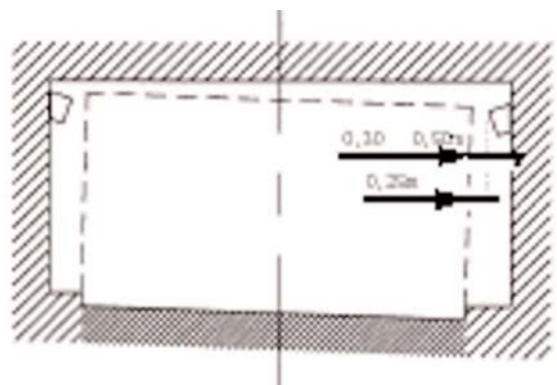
Perfil cuadrado instalación bilateral
